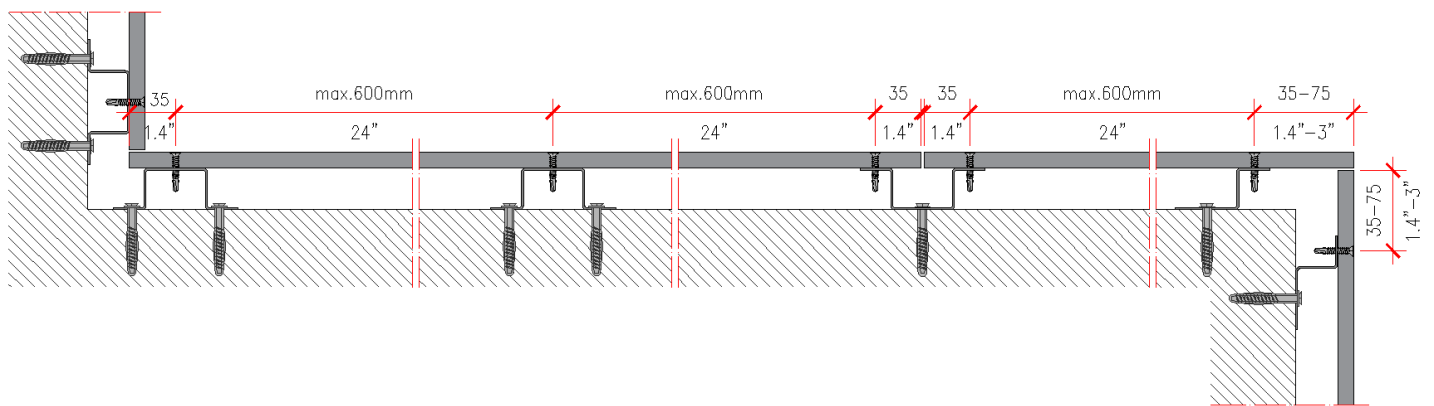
Secção horizontal de revestimento de parede, estrutura de aço galvanizado
